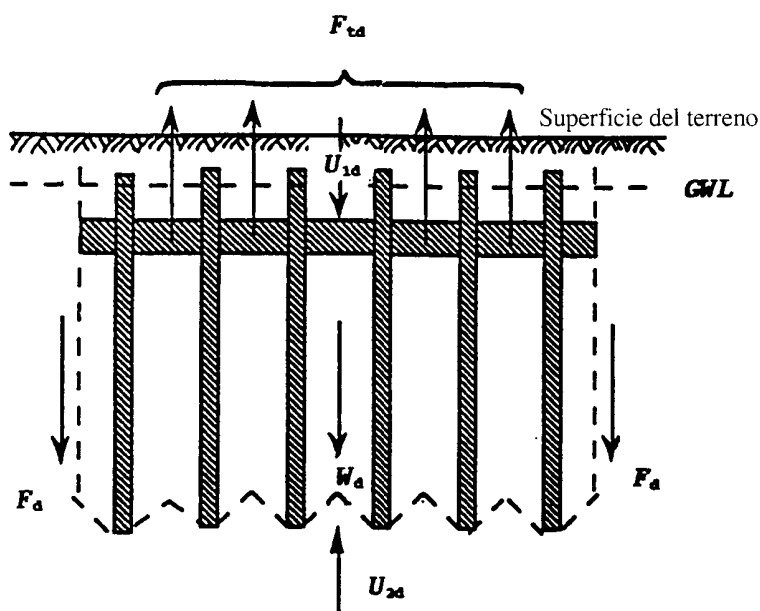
Rotura por levantamiento de un grupo de pilotes sometidos a tracción
